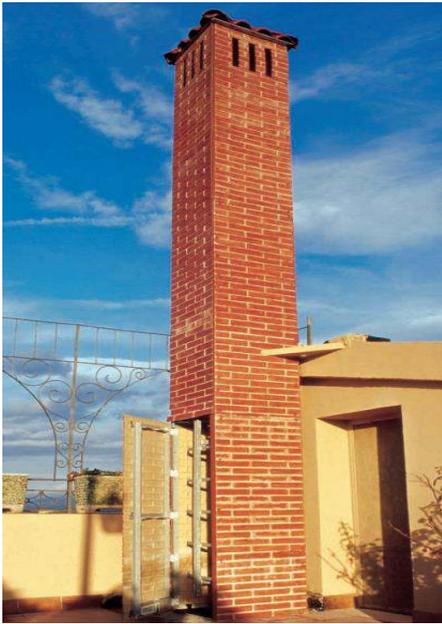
Mimetizado Combinado Fachada y Paneles de Lamas
